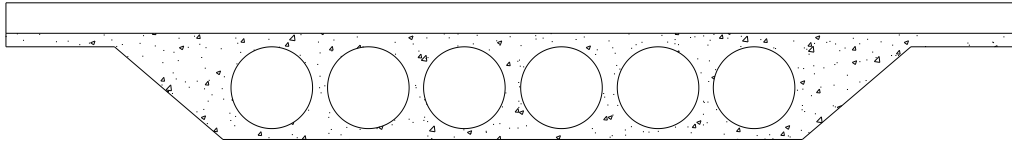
Sección transversal de puente con losa aligerada de concreto reforzado colado *in situ* (Villarino Otero, 2010)
